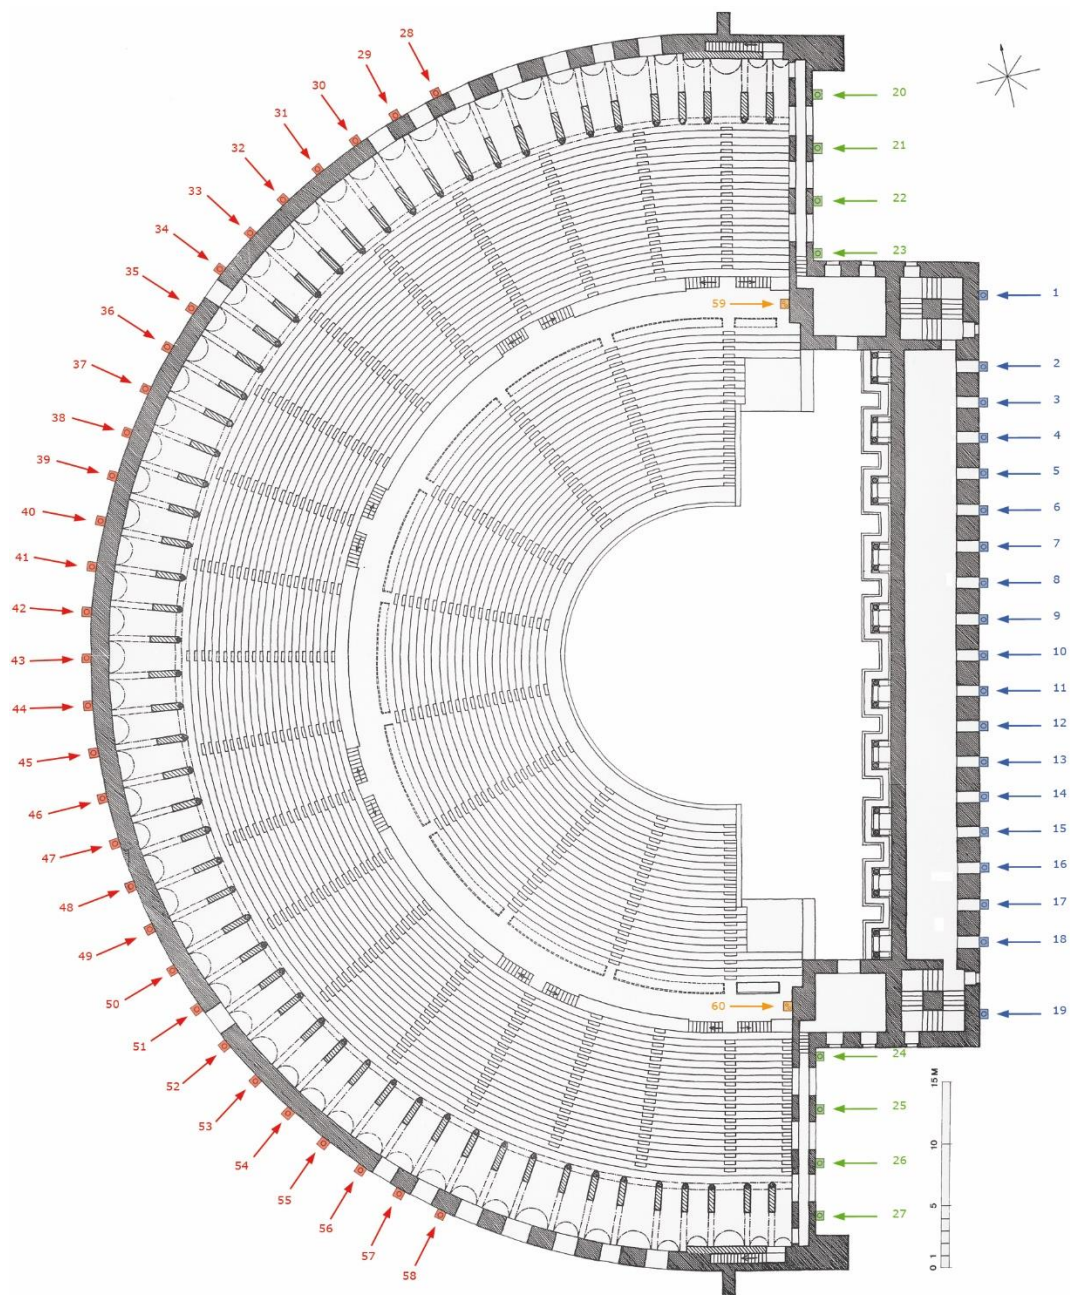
Localisation des consoles sur le plan du théâtre d'Aspendos
